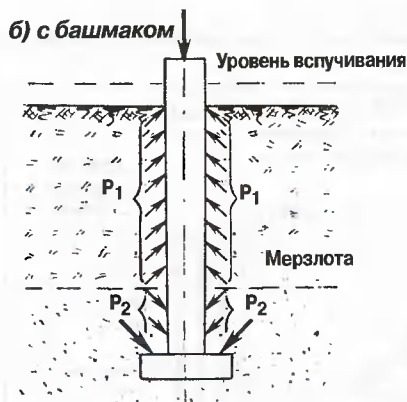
Схема нагрузок, действующих на столбчатый фундамент
